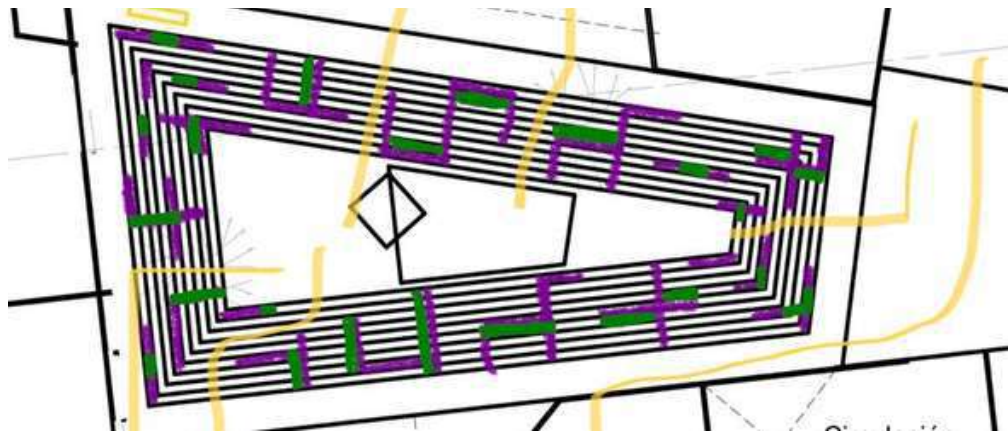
Planta arquitectónica intervenida con análisis de circulaciones. Fuente: Autoría propia
